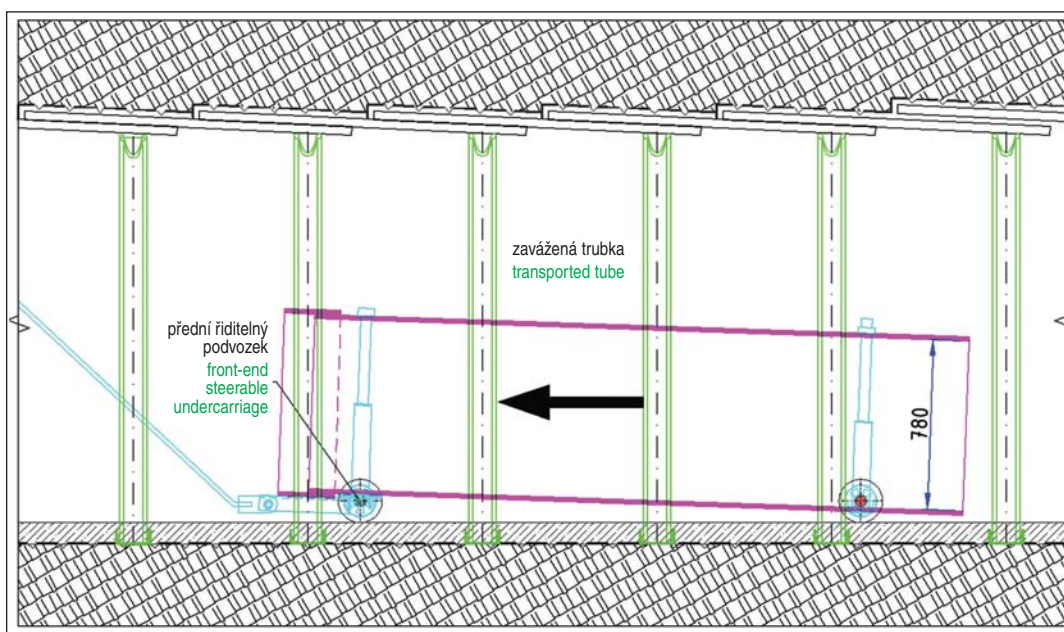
Spojování trubek GRP – půdorys – Troja, půdorys
